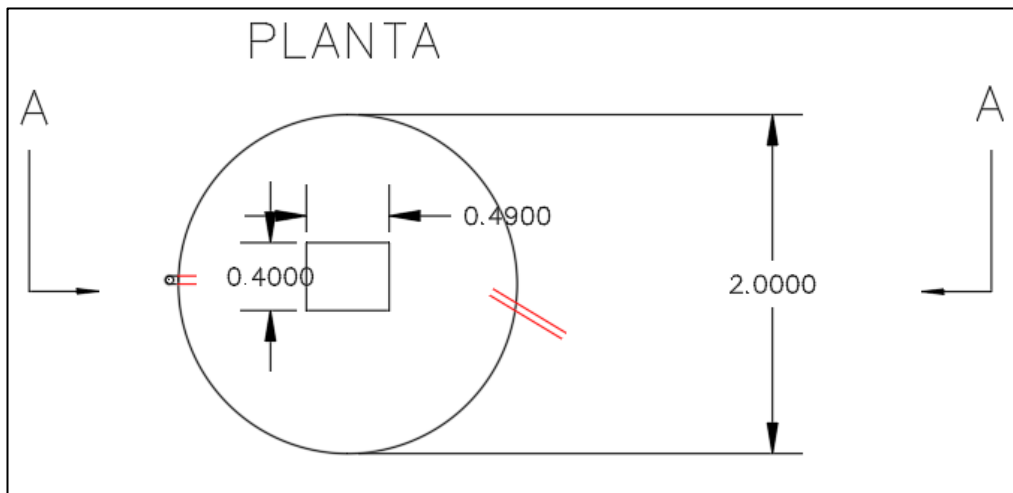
Tanque de almacenamiento principal existente – vista planta
